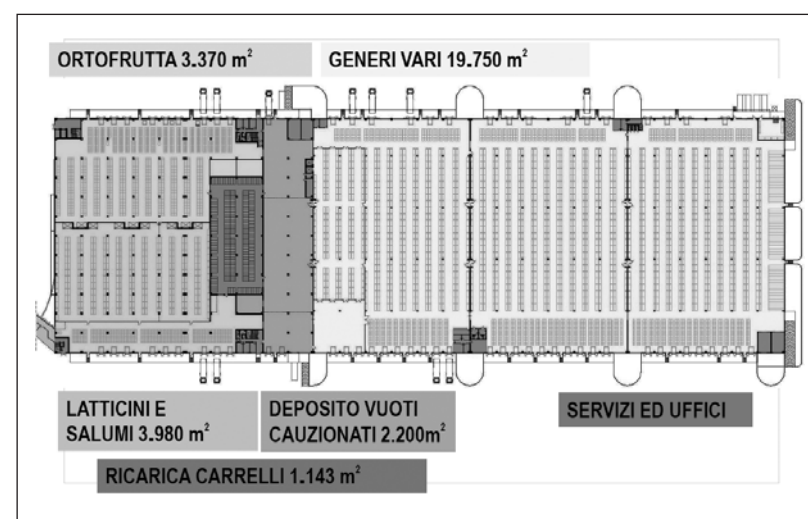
Pianta del nuovo Ce.Di. SAIT di Trento
